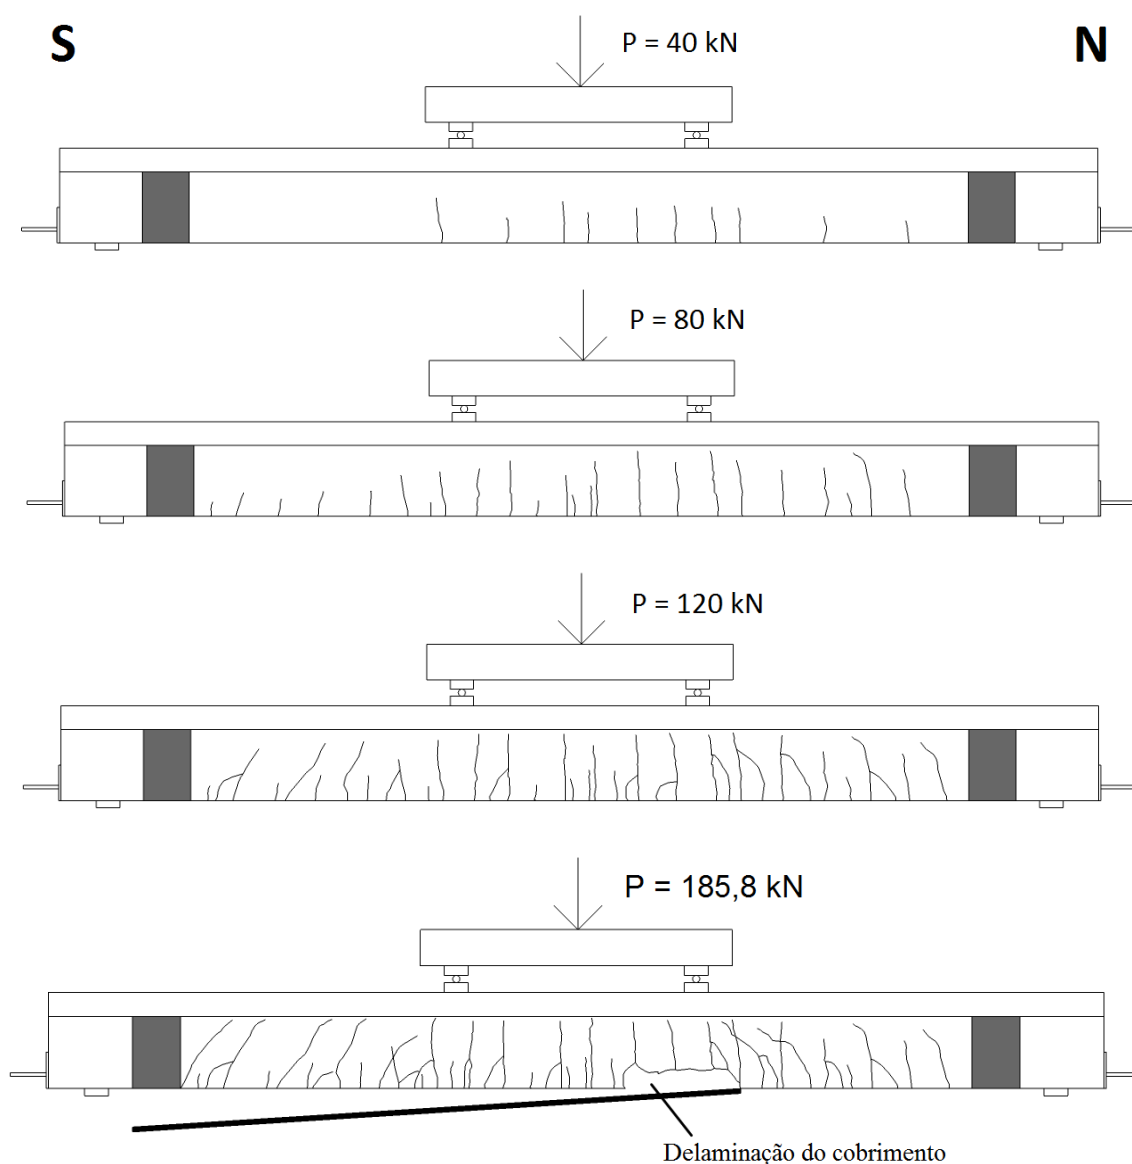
Evolução da fissuração na viga VA3 - VV
